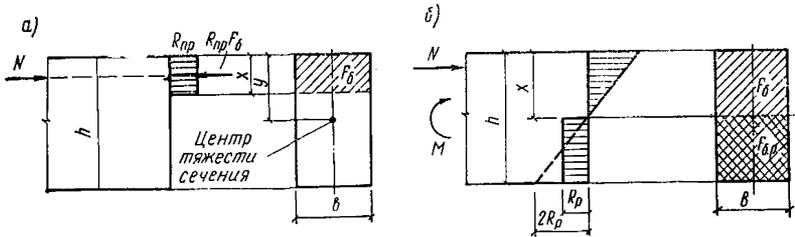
Схема усилий и эпюра напряжений в сечении, нормальном к продольной оси
